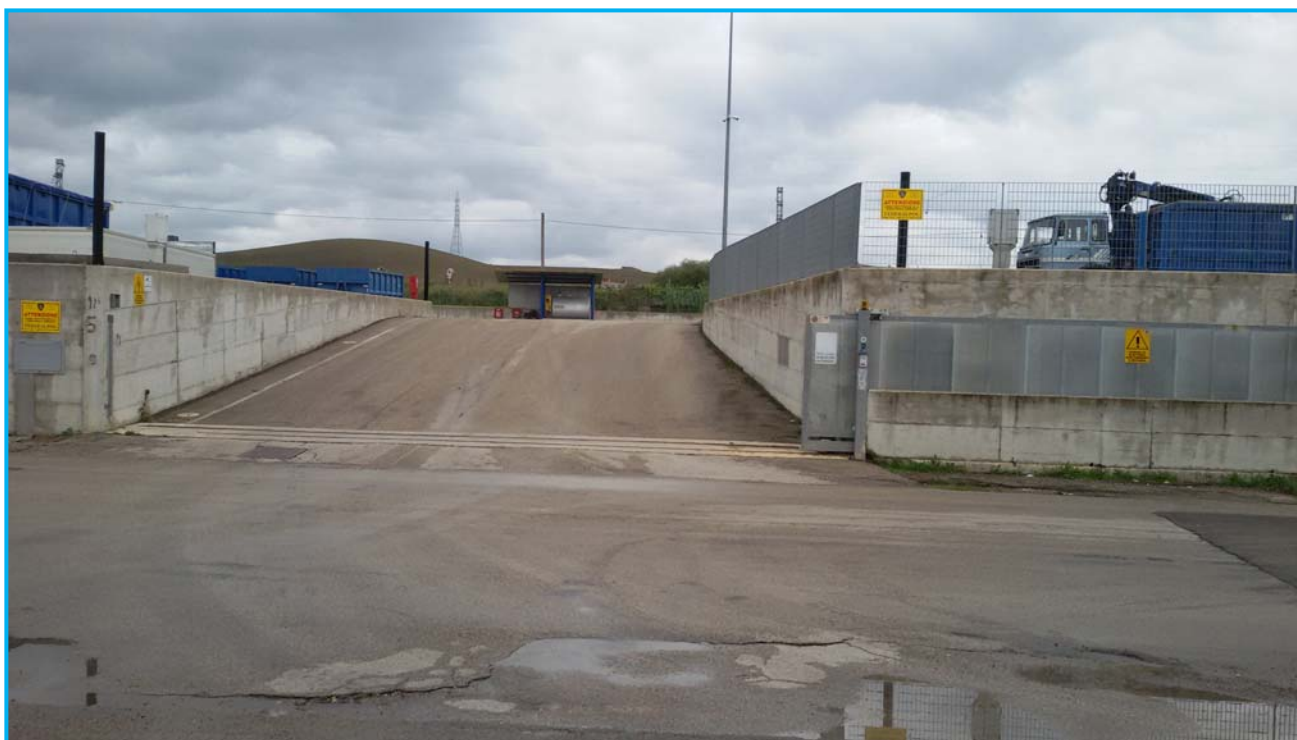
FOTOGRAFIA: Accesso dalla strada del consorzio industriale – ACCESSO N. 2
